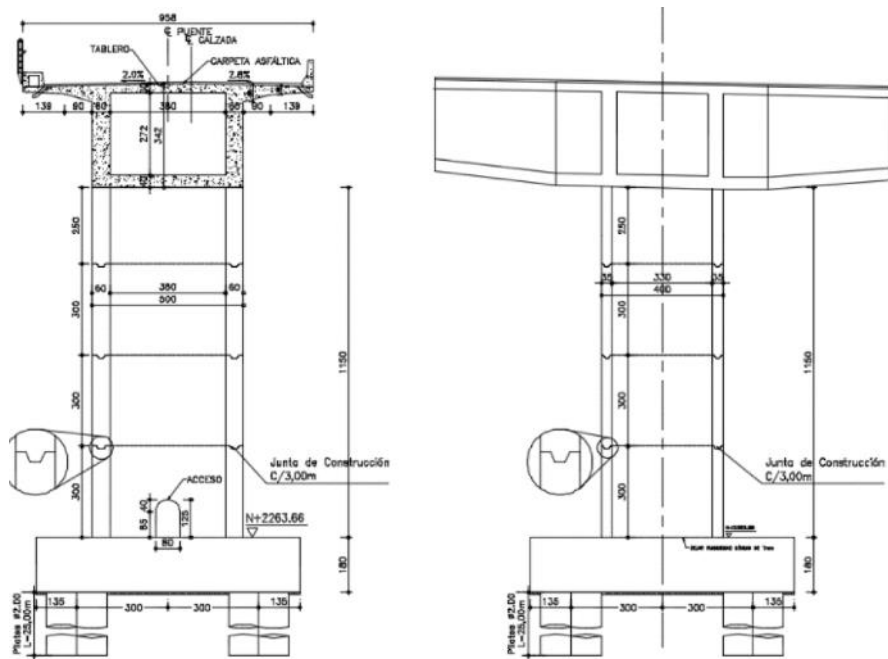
Geometría del apoyo eje 2 del puente Bermúdez.
